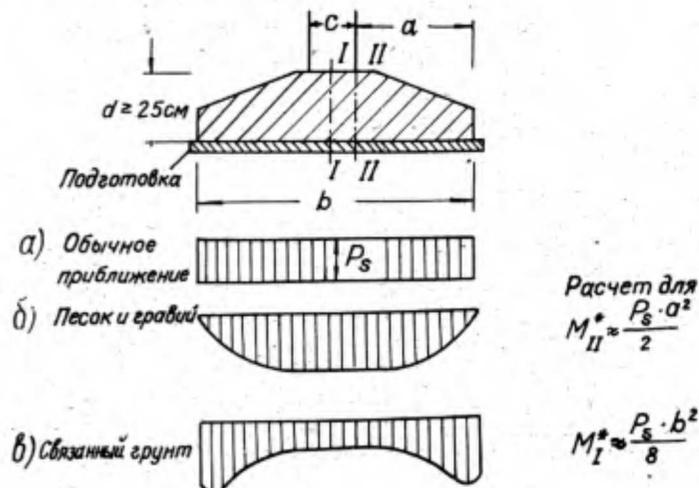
2. Давление на грунт при ленточных фундаментах
